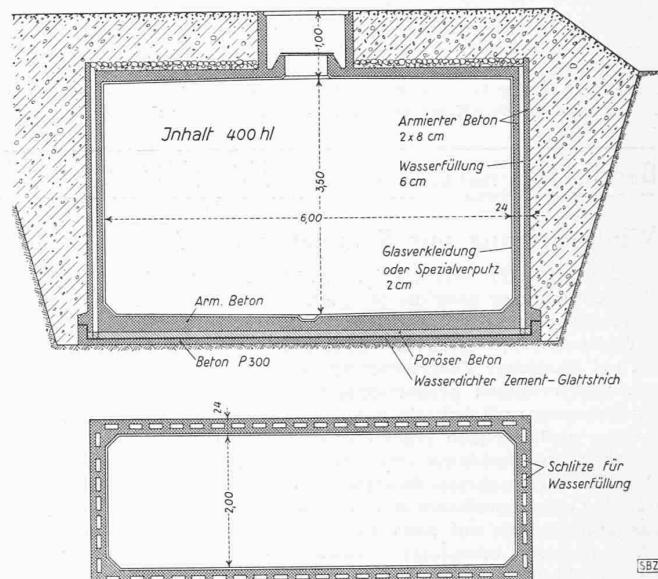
Borsari-Tank mit Wasserkammern in Eisenbeton für unterirdische Benzin-Lagerung in Zürich-Affoltern. — 1:100
